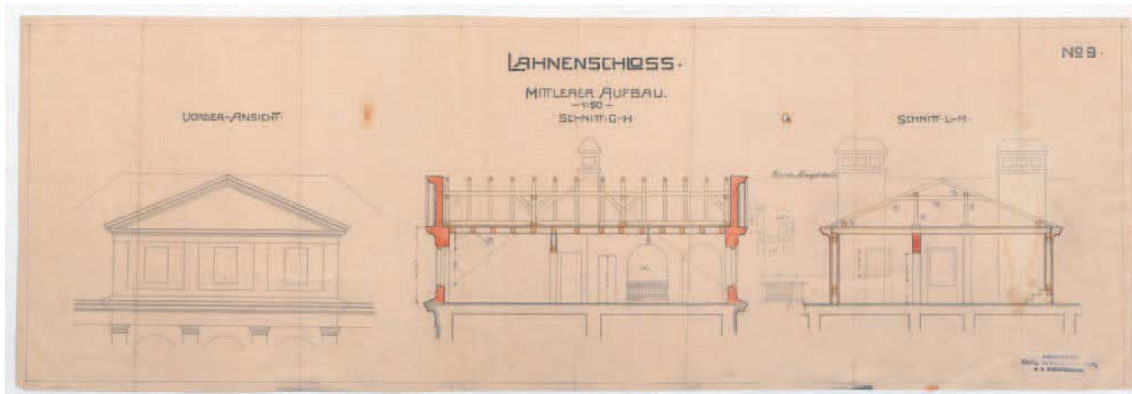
Kolorierter Plan der Umbauarbeiten des Lahnschlüssels / Kolorovaný plán stavebních úprav na zamečku Lány „LAHNENSCHLOSS, № 9, MITTLERER AUFBAU, 1:50“, Carl Weinbrenner, undatiert / nedatováno.
